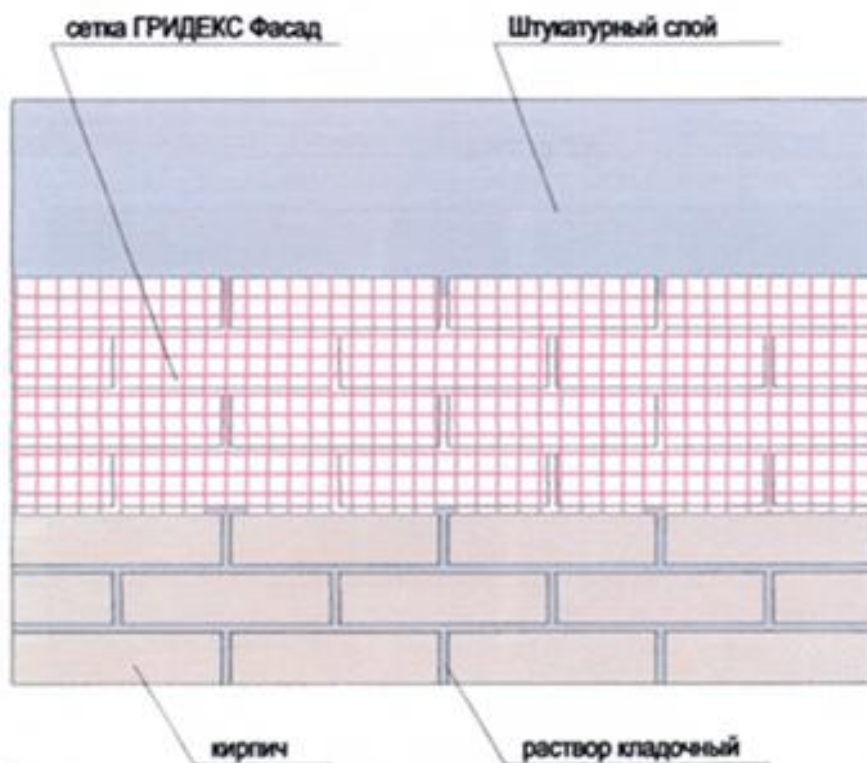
Сетка «ГРИДЕКС Фасад» для армирования штукатурного слоя и устройства «мокрого» фасада
